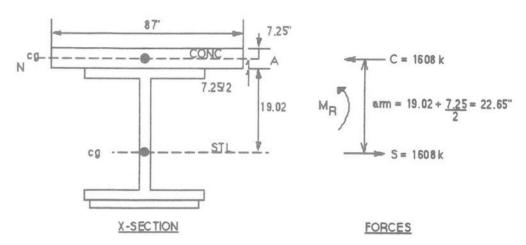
B.1.6.3-1—Sección transversal—Larguero interior, para determinar la capacidad de momento plástico Mp
